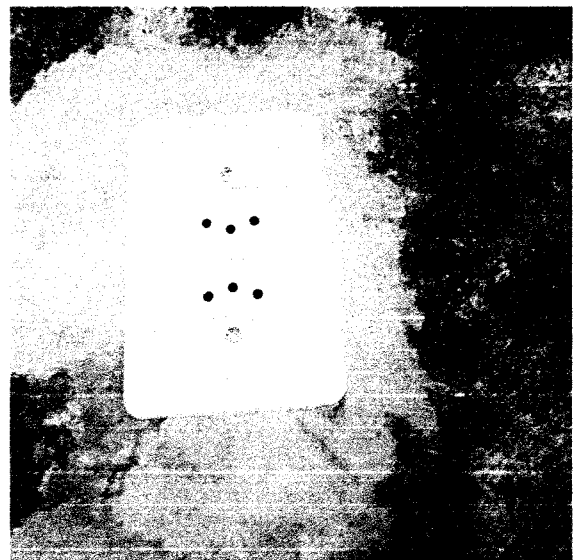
Tomadas 2x2P+T e 2P+T instaladas.
